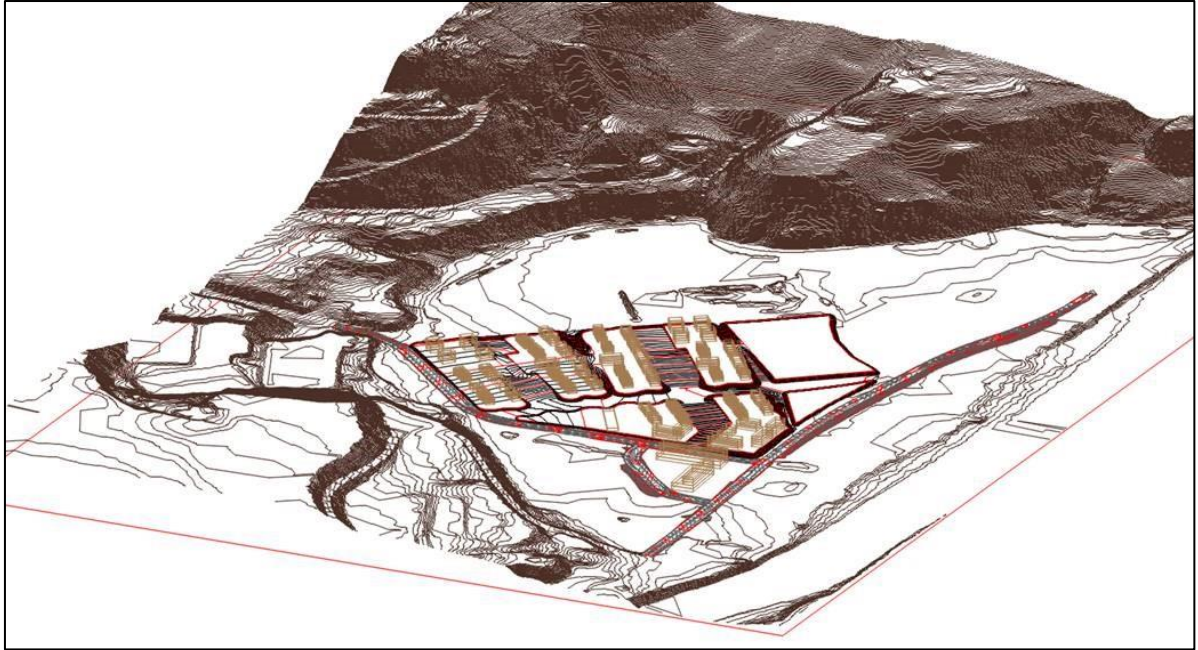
, viser en skisse av planområdet med to store boligområder (skravert), hvor det er tiltenkt ulike typer private boliger og kommunale boliger. Det er denne skissen som er benyttet videre i vurdering av flomfare på planområdet. En nyere versjon av planområdet ble oversendt i ettertid av modelleringsarbeidet og er lagt ved for bedre å visualisere planområdet, se Figur 2. Elven Gaula renner på østsiden av planområdet, mens Varmubekken har sitt løp nordvest for planområdet. I planarbeidet er det foreslått omlegging av fylkesvei 6606 (Strandvegen) og 6604 (Drammensvegen/Varmbuvegen).
